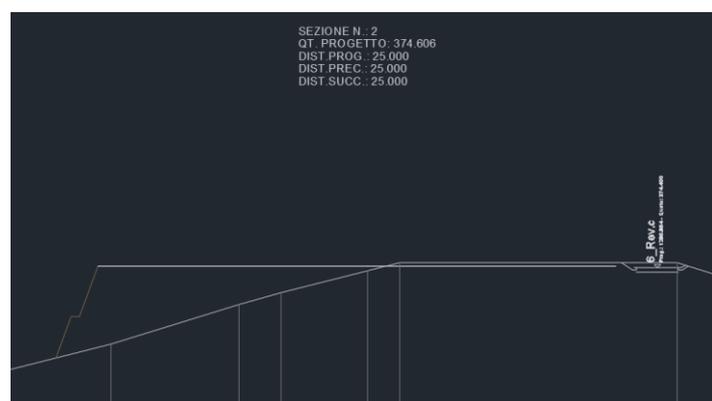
(a sinistra) Dettaglio terre rinforzare sinistra – Sez. 2 piazzola WTG6
